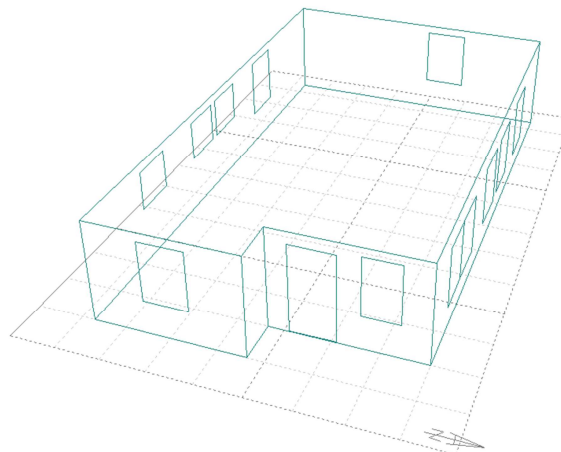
Modelo de las paredes perimetrales con las ventanas y puertas de la vivienda propuesta en ECOTECT®
